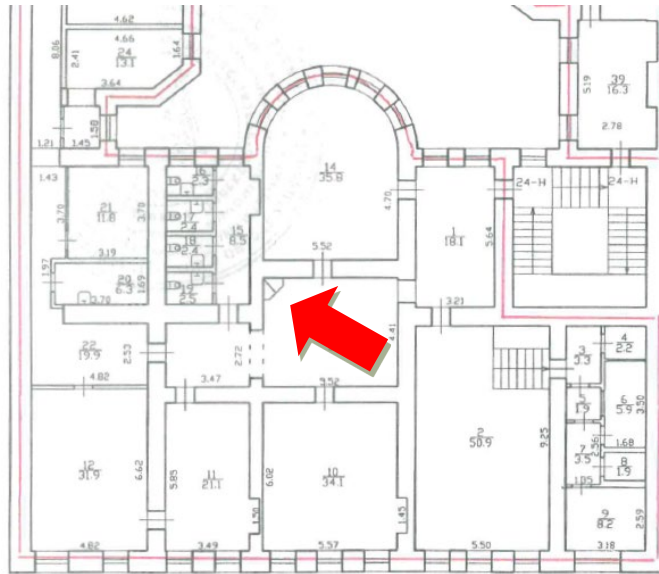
Помещение №12. Холл. Угловой печь-камин (предмет охраны).
